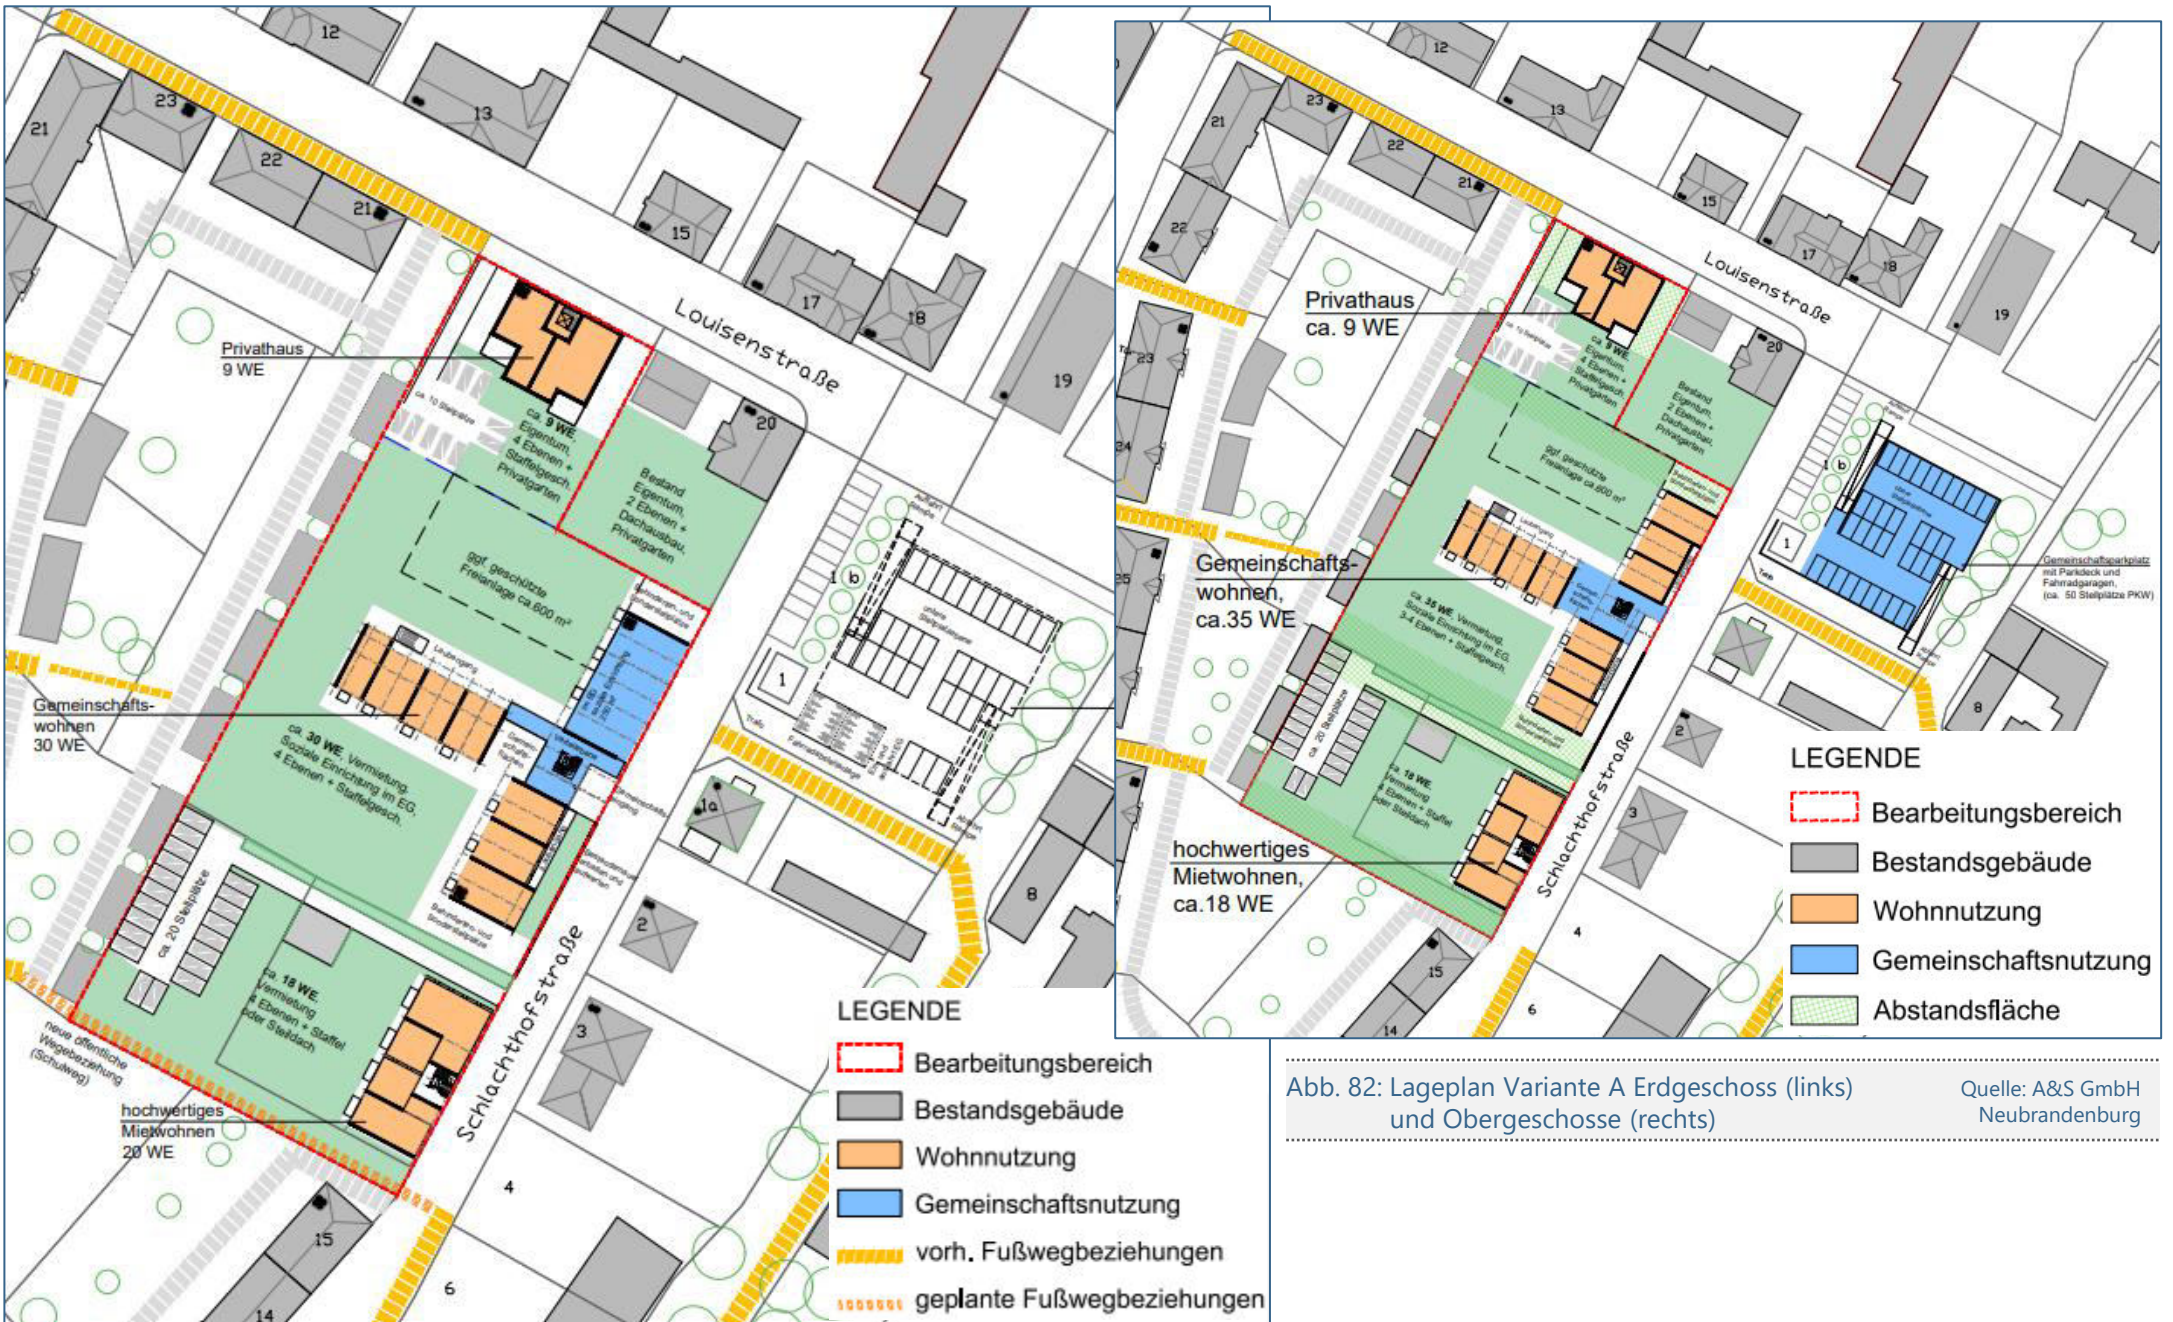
Lageplan Variante A Erdgeschoss (links) und Obergeschosse (rechts) Quelle: A&S GmbH Neubrandenburg
